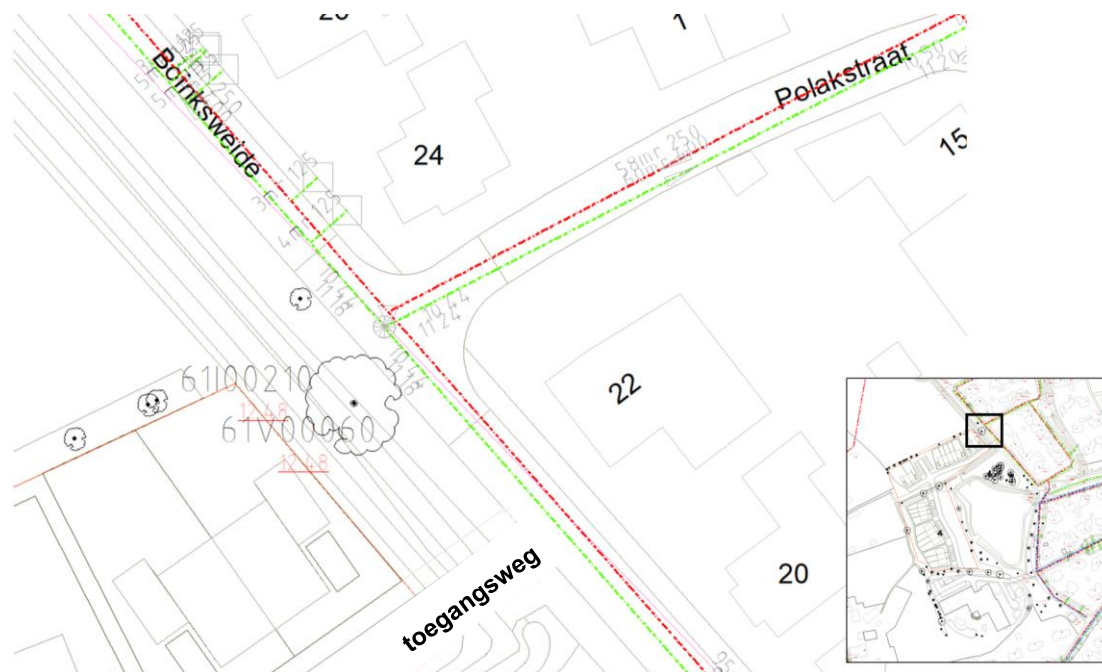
Overzicht riolering in de omgeving van het plangebied
